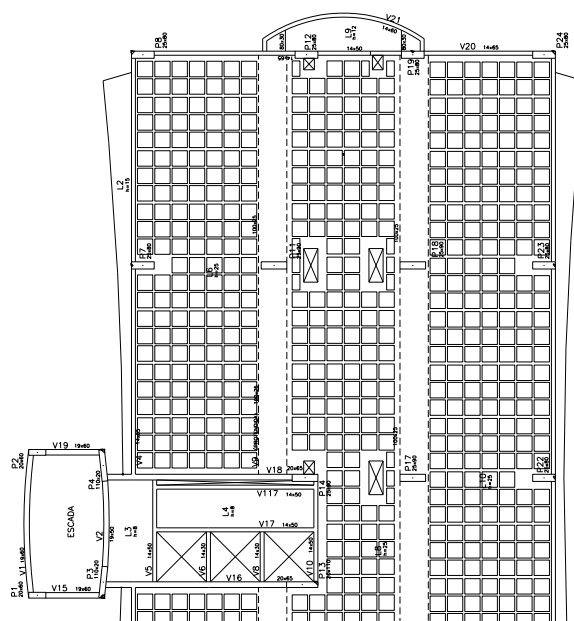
Edifício HC Plaza – Vigas faixas + Lajes nervuradas.
